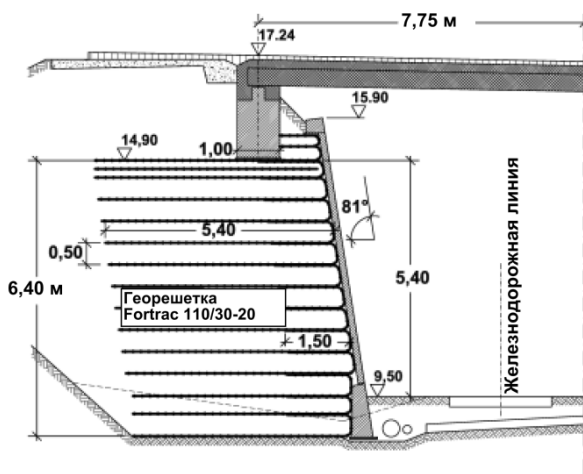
Подпорная стена из армированного грунта с облицовкой из железобетона в поперечном разрезе, Уллерслев, Дания 1991, [1]
